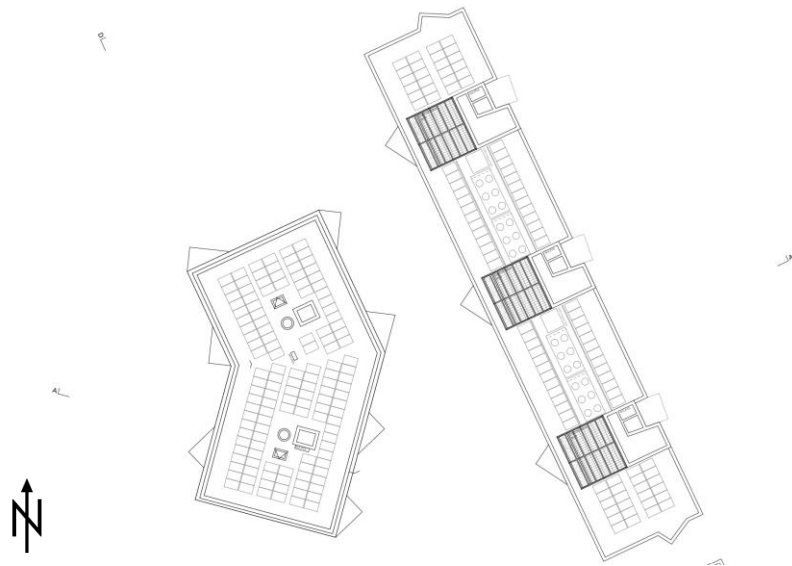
Richtprojekt, Dachaufsicht, dat. 27.06.2025
